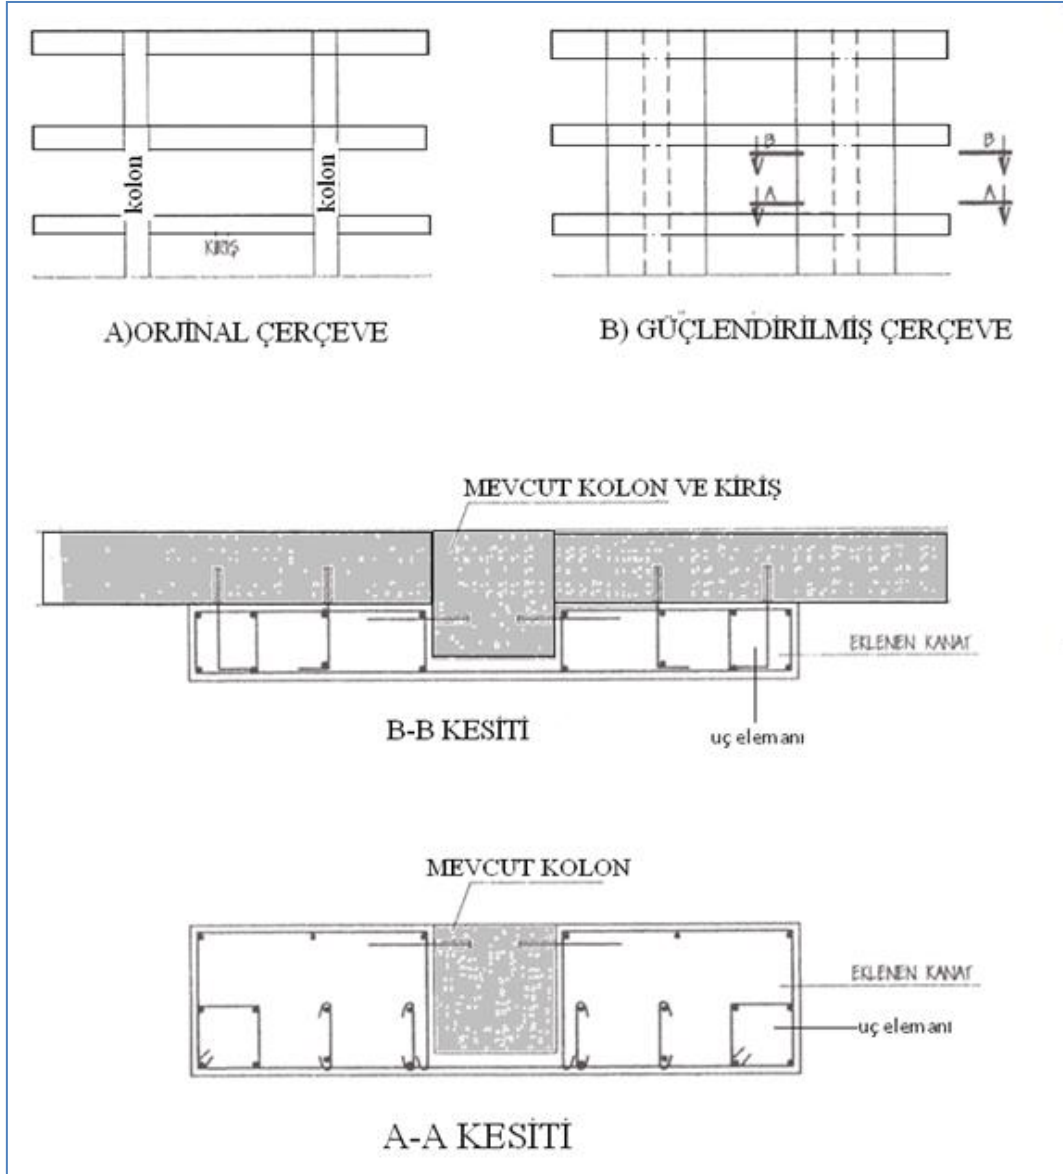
Betonarme kolonun "perde duvara dönüştürülerek" güçlendirilmesi
